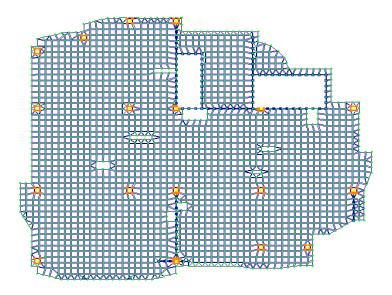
Расчетная схема плиты перекрытия с приложенной к ней нагрузкой
